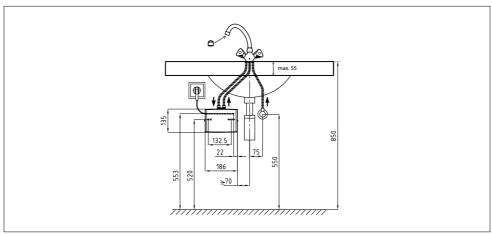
»Installation mit Armatur« (Maßangaben in mm)
